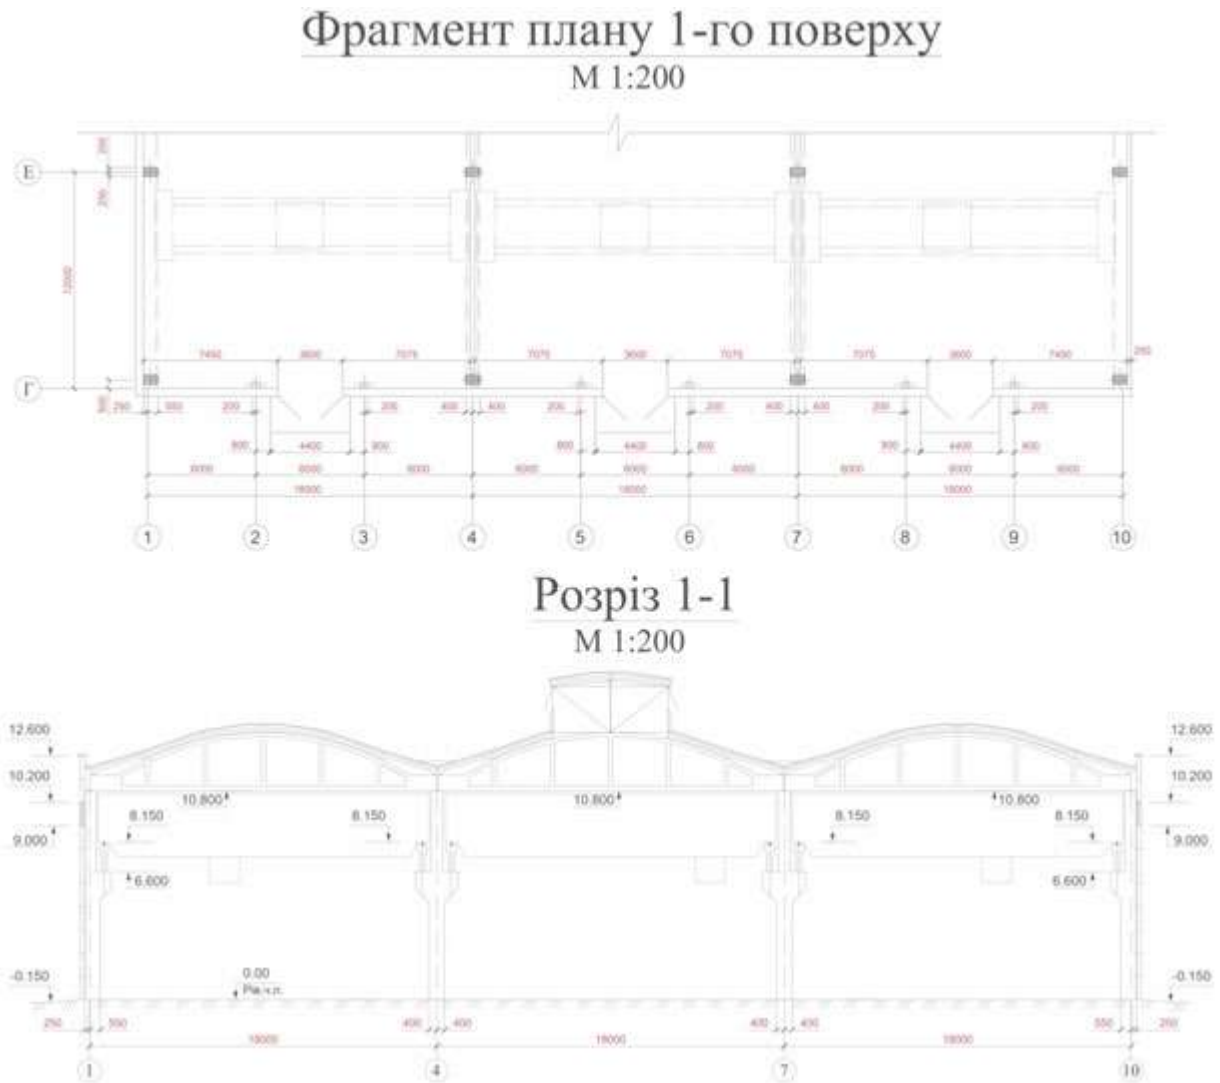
Об'ємно-планувальне рішення будівлі
